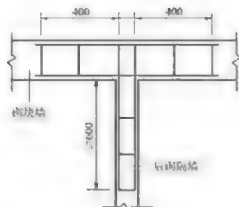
砌块墙与后砌隔墙交接处钢筋网片
